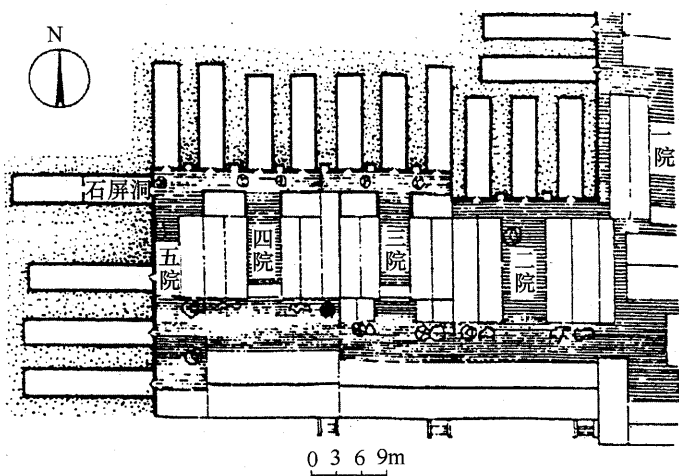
河南巩县康百万庄园靠崖窑群平面图
